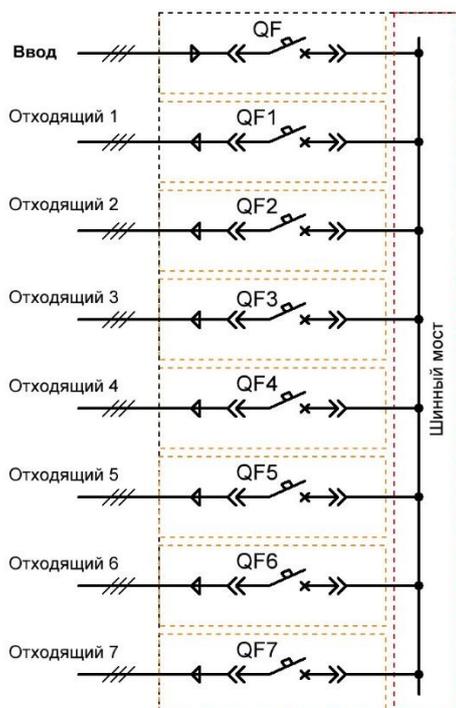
Схема однолинейная ШР-ПП-100...1600А с выдвижными автоматическими выключателями.
